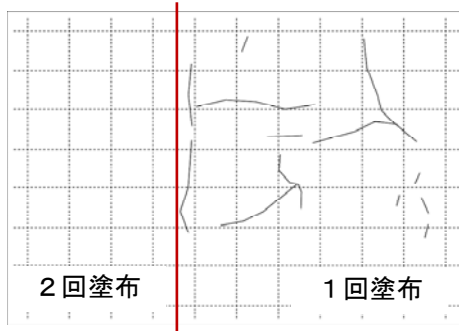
ひび割れ発生状況 (散水有り2.5時間)
